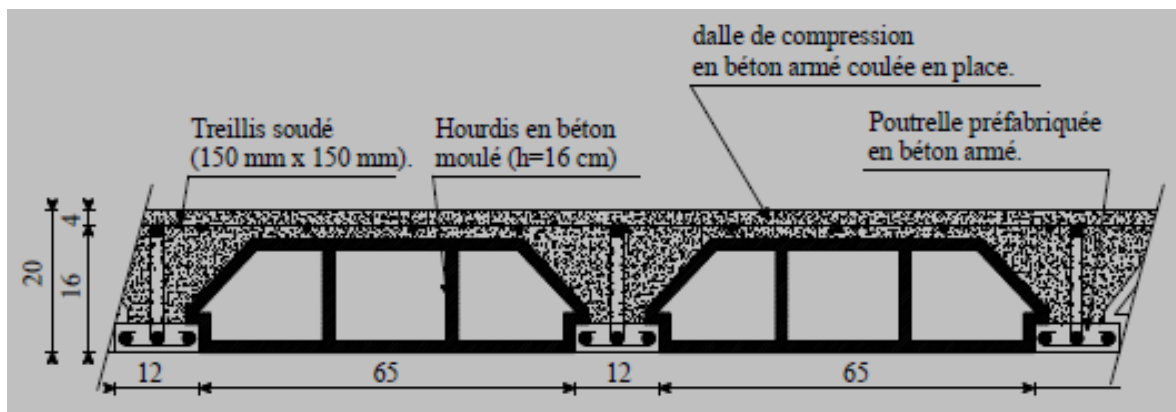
vue en coupe d'un plancher en corps creux (16+4) [cm].
